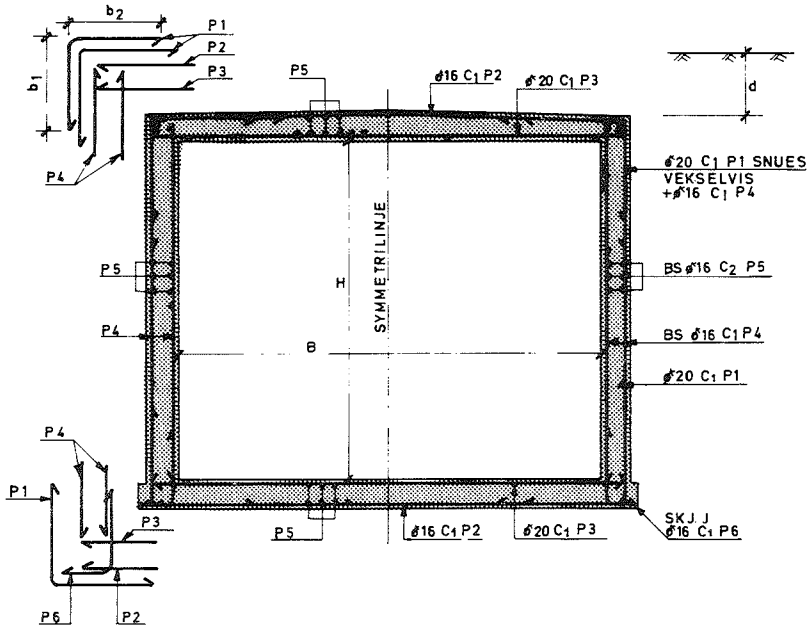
Armering, jordbrukskulvert og fotgjengerunderganger
